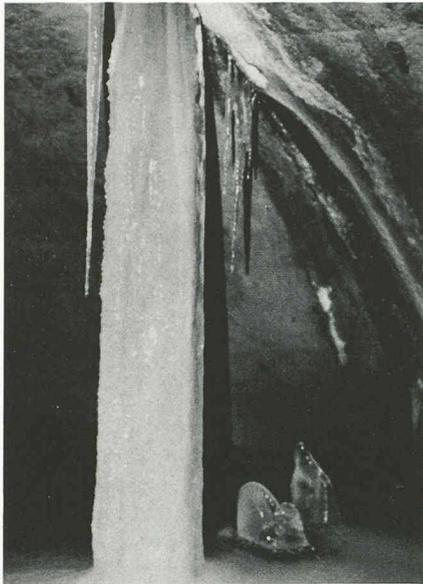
Formation de glace dans la calotte (canal d'air frais) et sur le faux plafond, par manque d'étanchéité.
